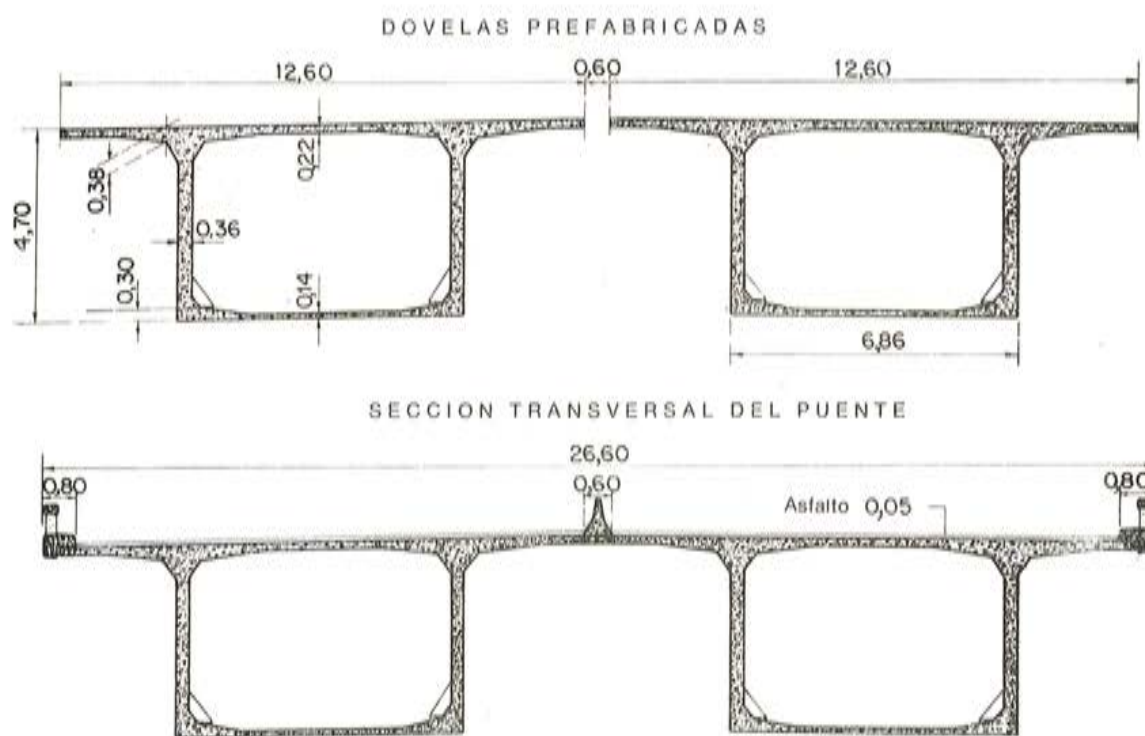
Sección de las dovelas prefabricadas y del puente.
